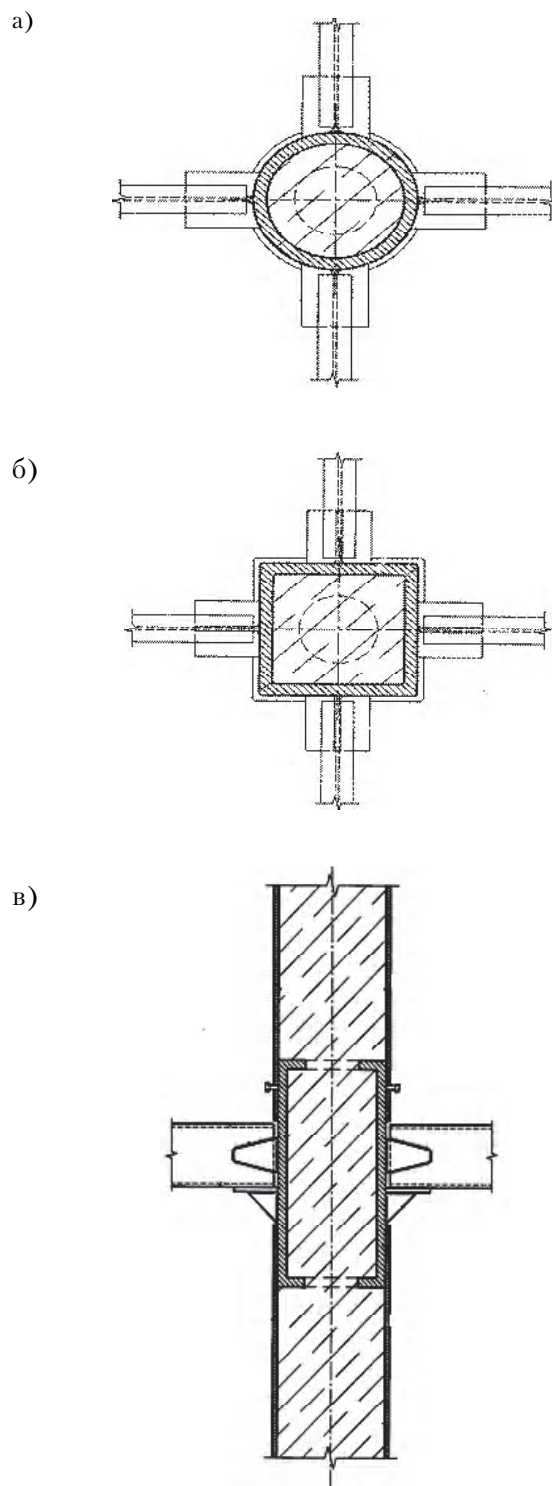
Узлы сопряжения трубобетонных колонн с балками перекрытия: а) с колонной круглого сечения; б) с колонной квадратного сечения; в) разрез ТБ колонны со стальным сердечником.
